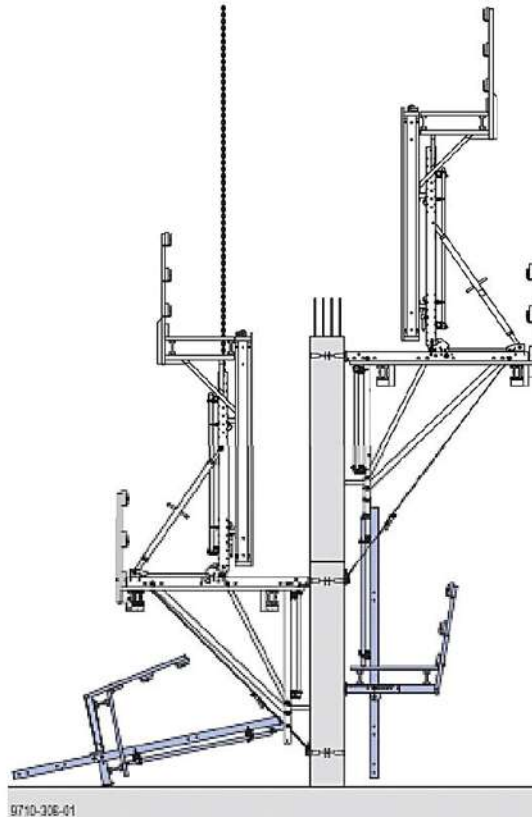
Izaje de los paneles y colocación de la plataforma inferior de trabajo.
